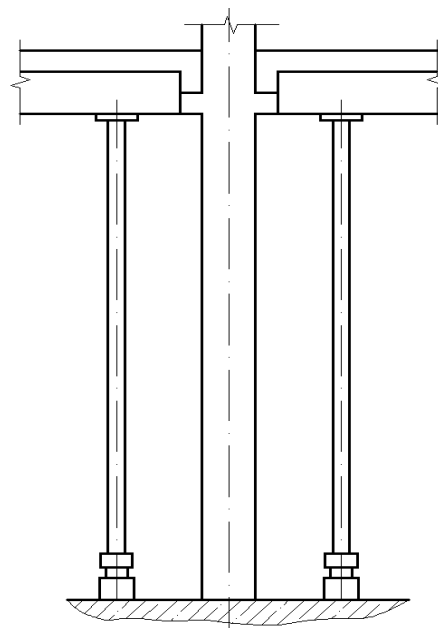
Розвантажування колон піддомкращуванням перед підсиленням
